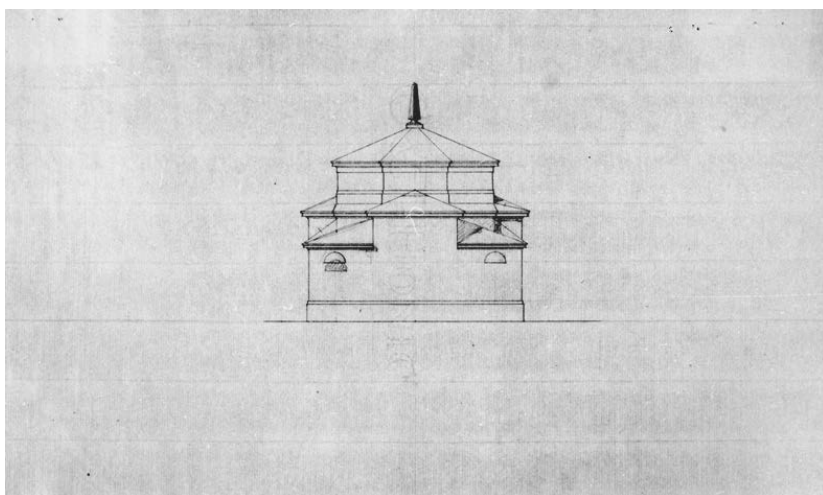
Silvestre Pérez, *Alzado de la fachada posterior de la Iglesia parroquial de Carrizosa*, 1805. ASF A-4018. 234 x 377 mm.
